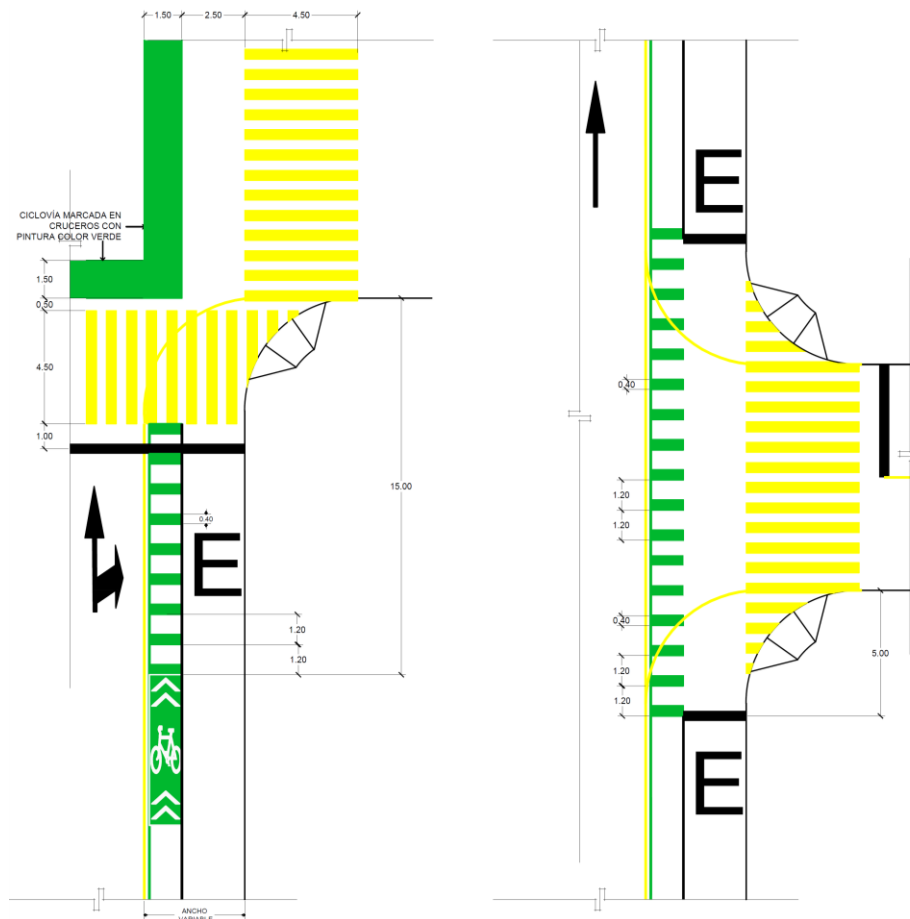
Detalle de señalamiento horizontal Tipo 3.
